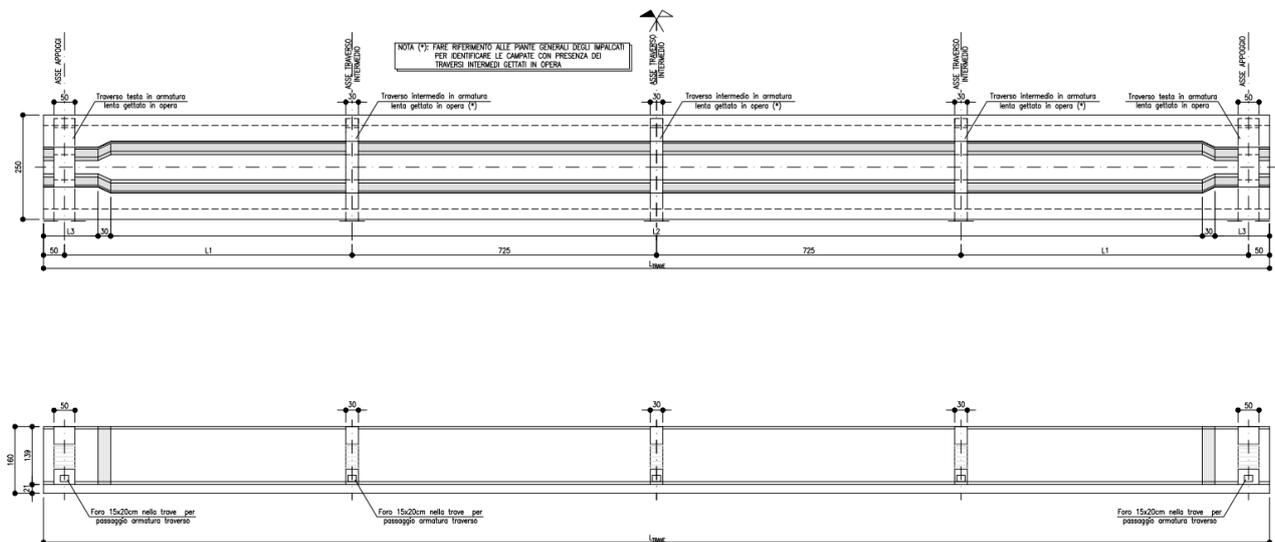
Pianta e prospetto della trave tipologica in c.a.p.
